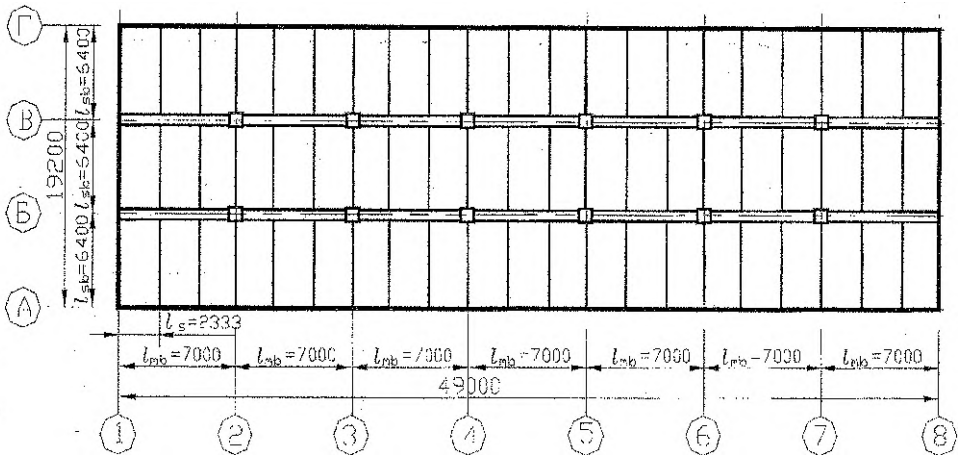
б. 2-ой вариант компоновки перекрытия.
